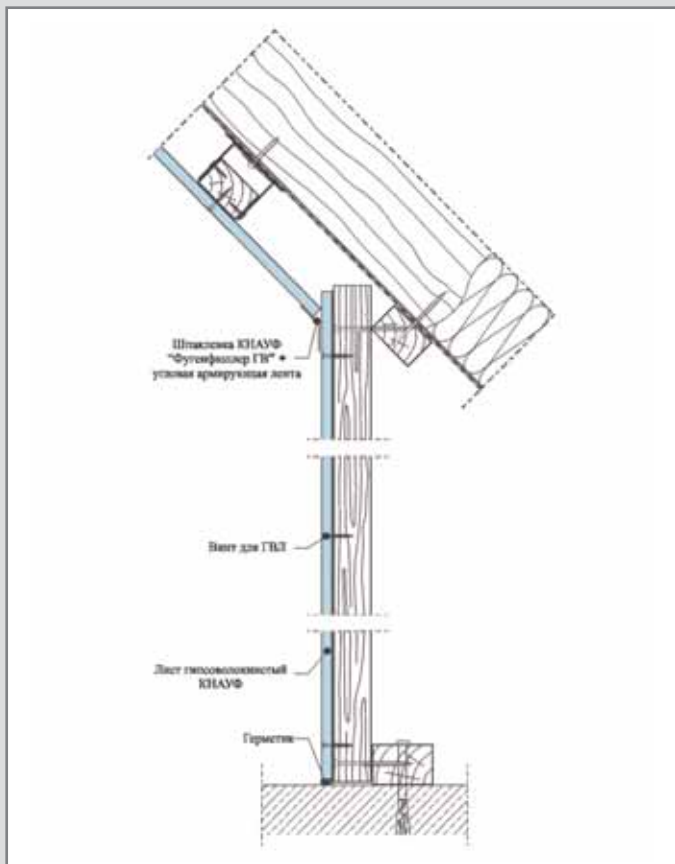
Прямое крепление стоек к брусу ската (вариант 1)
